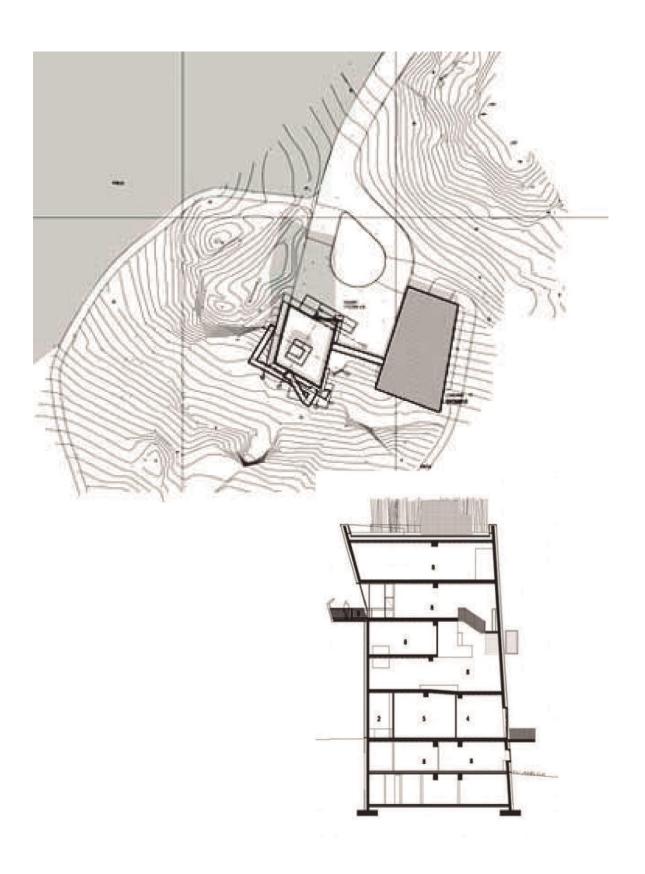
Planos del Proyecto del Museo Knut Hamsun. Planta de ubicación y corte.
